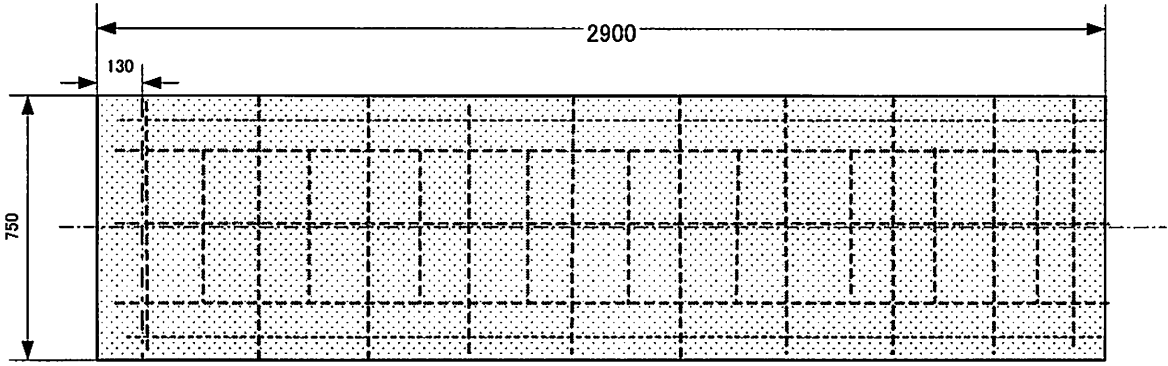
供試体② 鉄筋配置想定図(平面配置)
